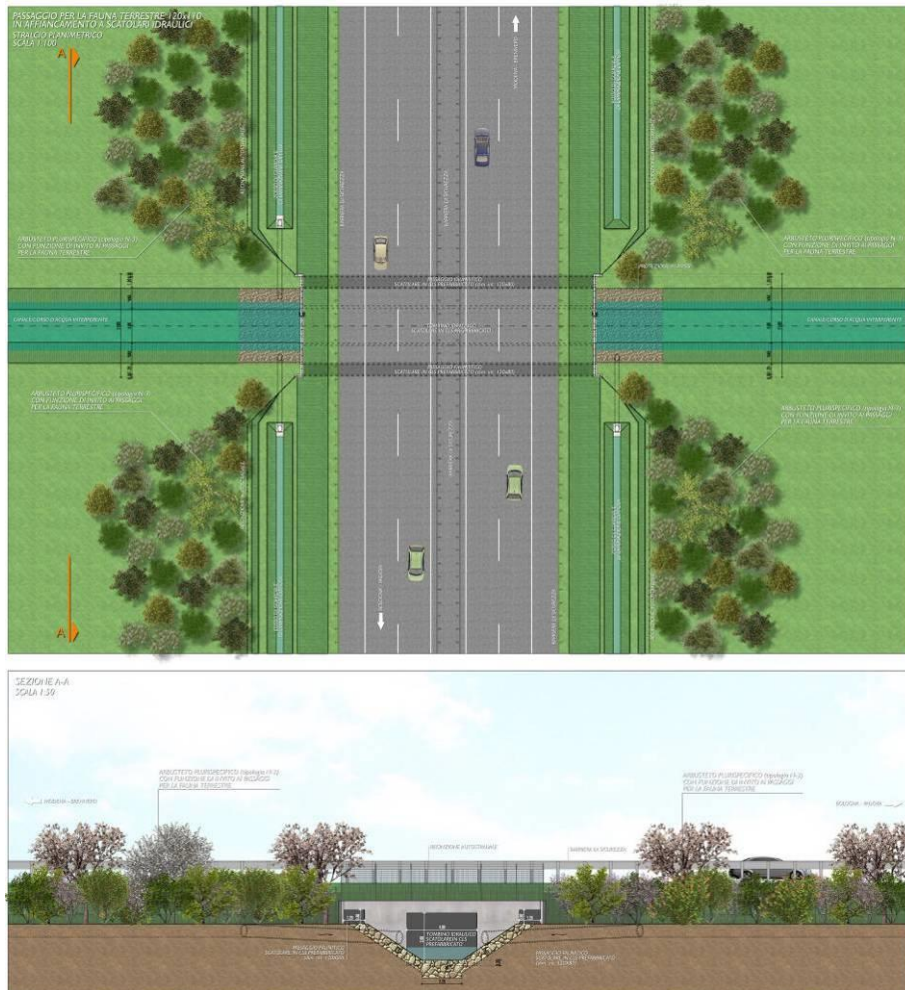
PASSAGGIO FAUNA : PIANTE E SEZIONE
